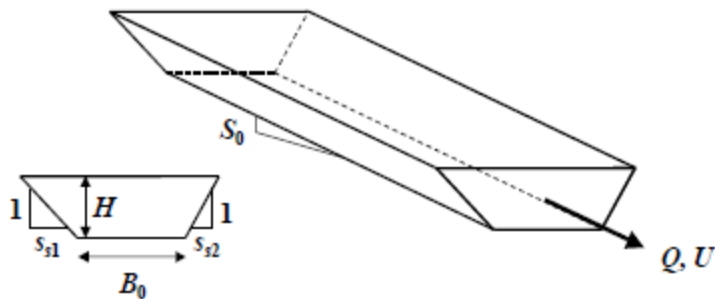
Canal de secção transversal trapezoidal (Pelletier et al., 2006)
